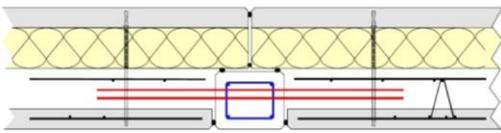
Poteau excentré coulé en place au droit d'un joint vertical
